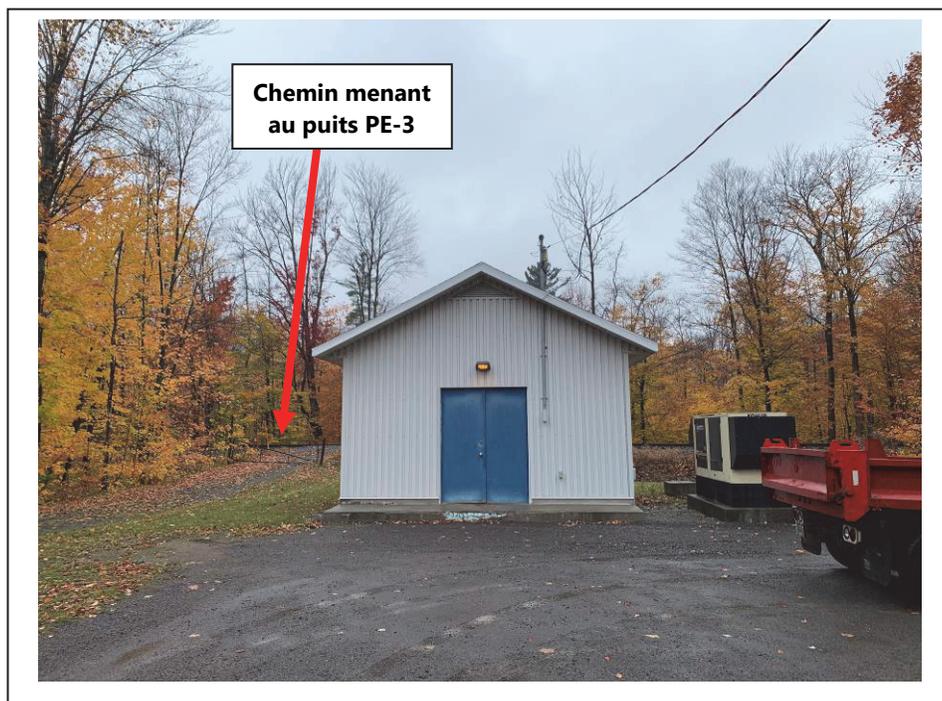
Vue de la station de pompage Saint-Pierre – 2020-10-13
